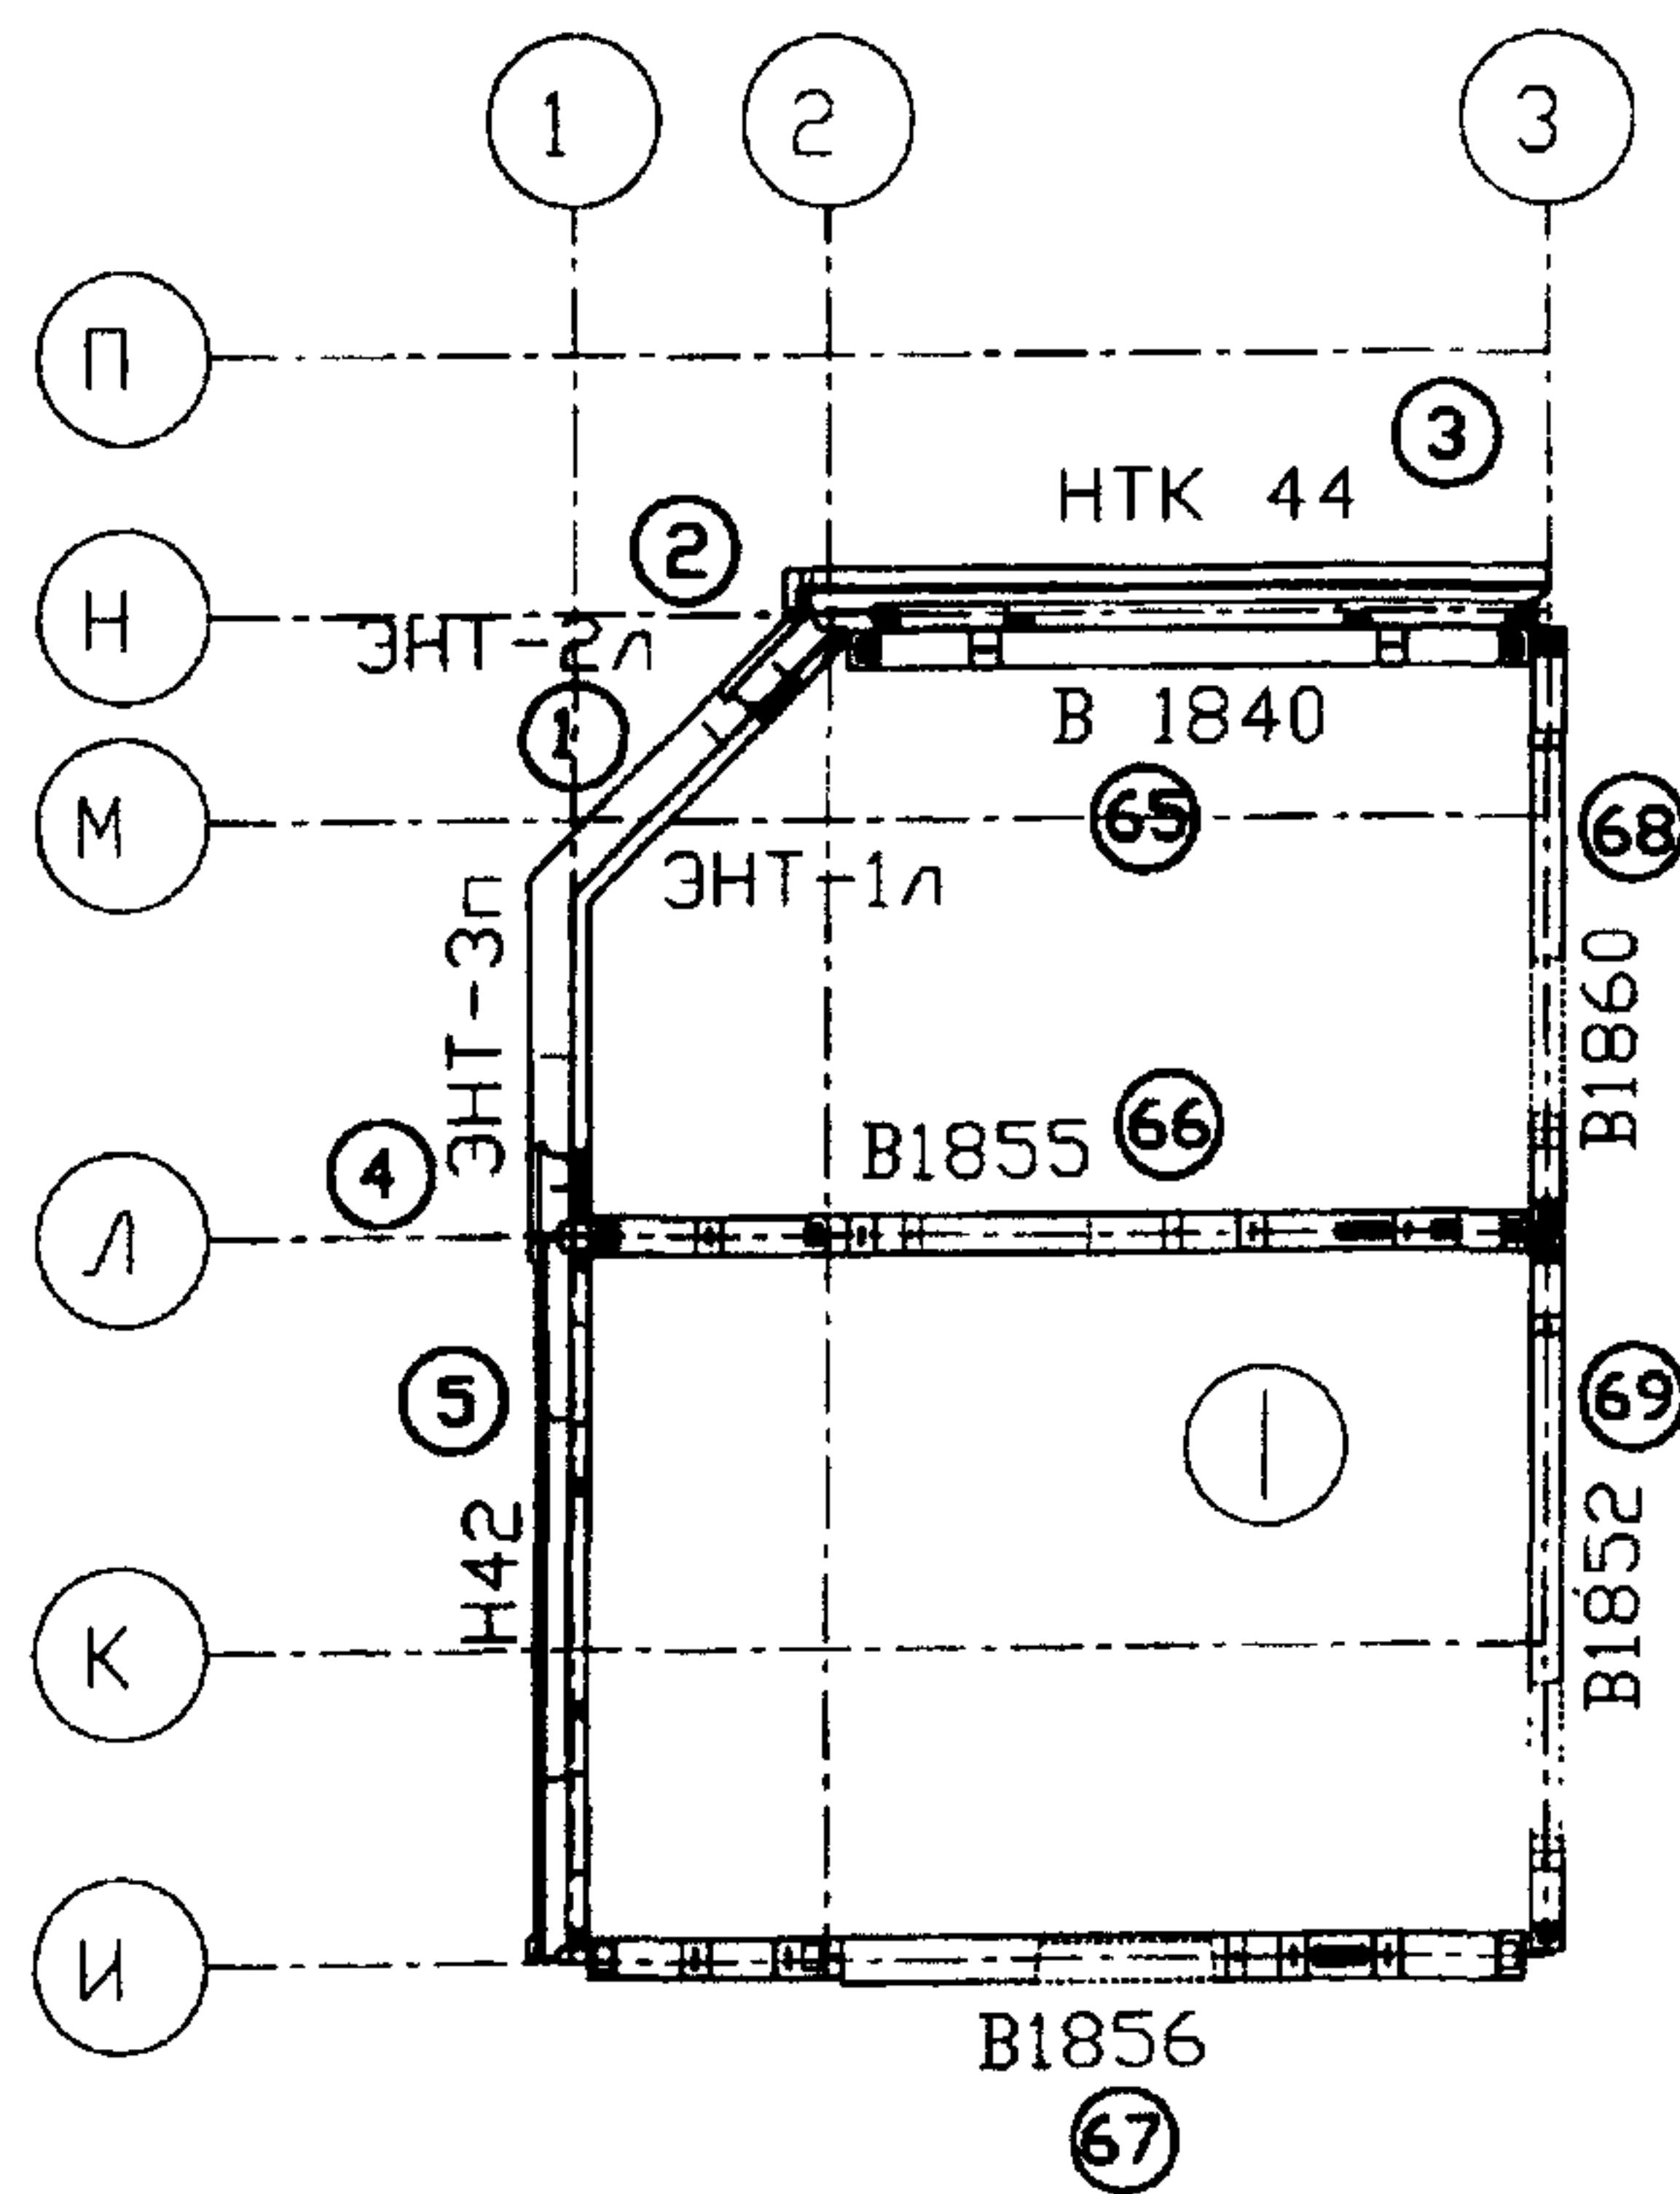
Схема монтажа стен, перегородок и других элементов этажа
